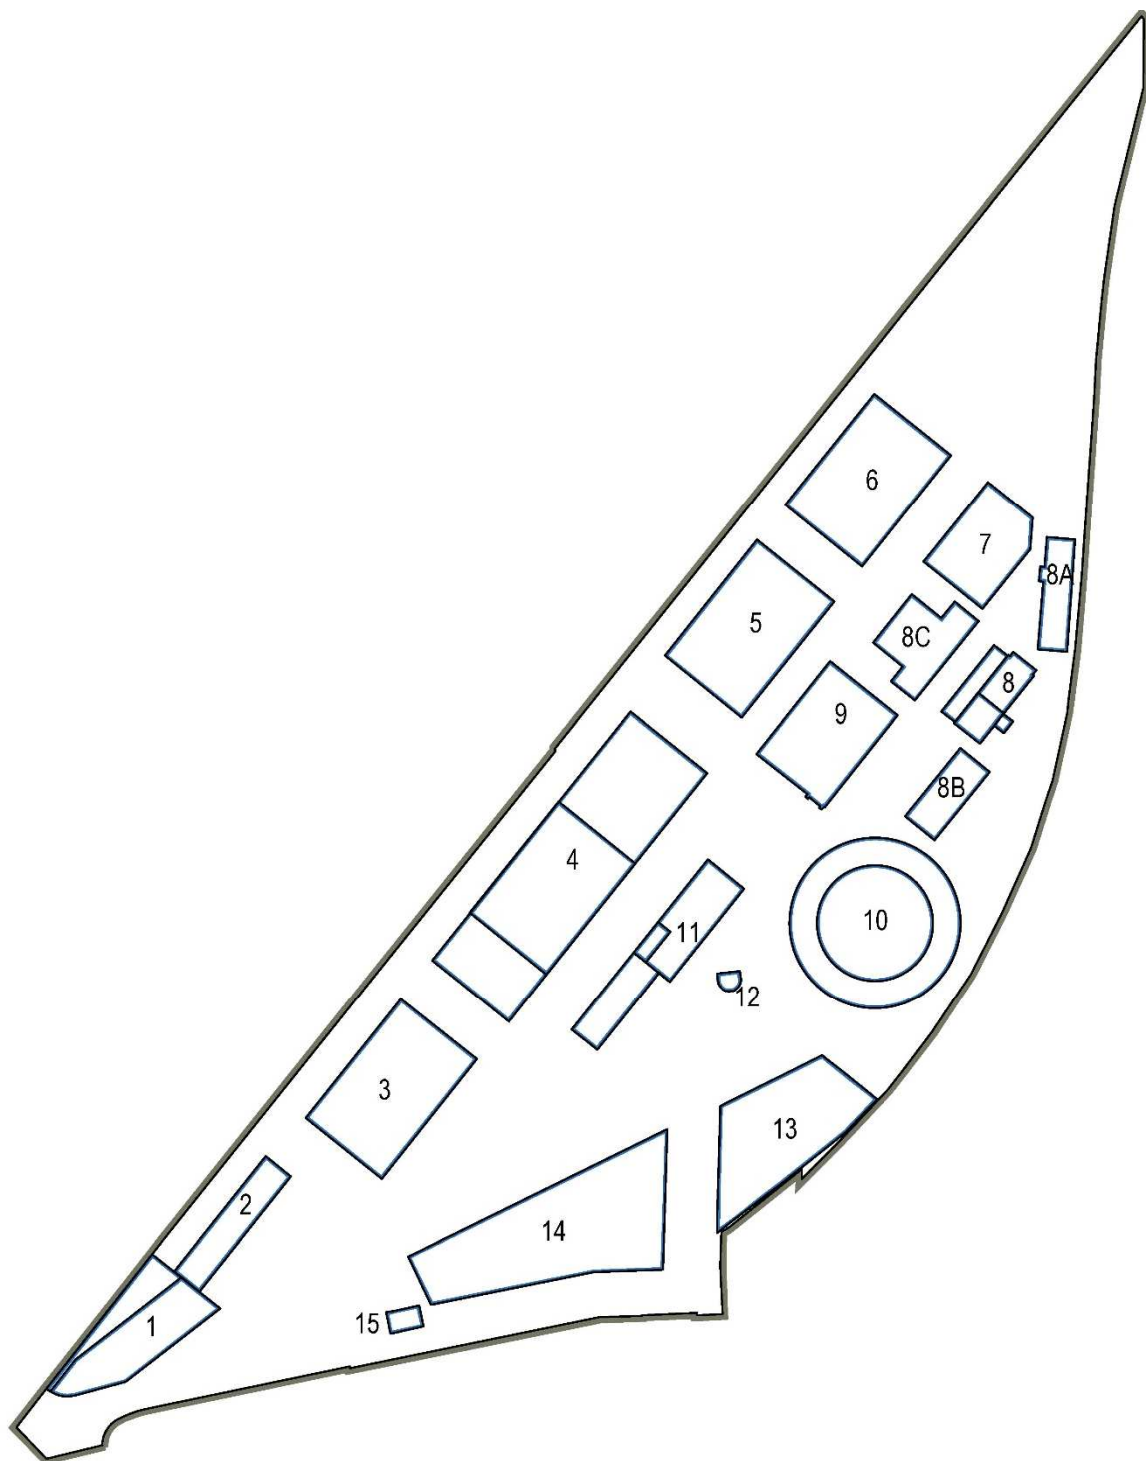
Lage und Nummerierung der Baukörperausweisungen gemäß Bebauungsplan-Entwurf 2020
